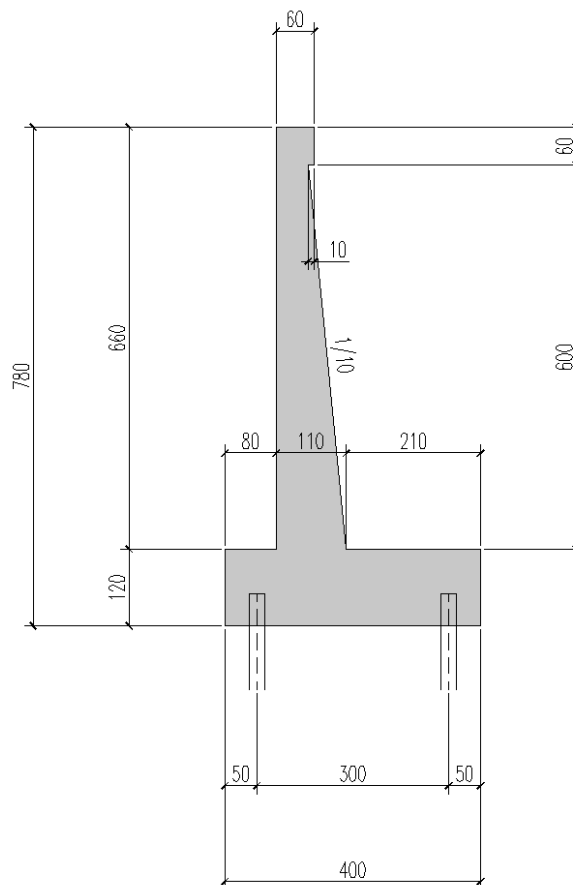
Carpenteria della Sezione ad altezza maggiore del Muro M02
